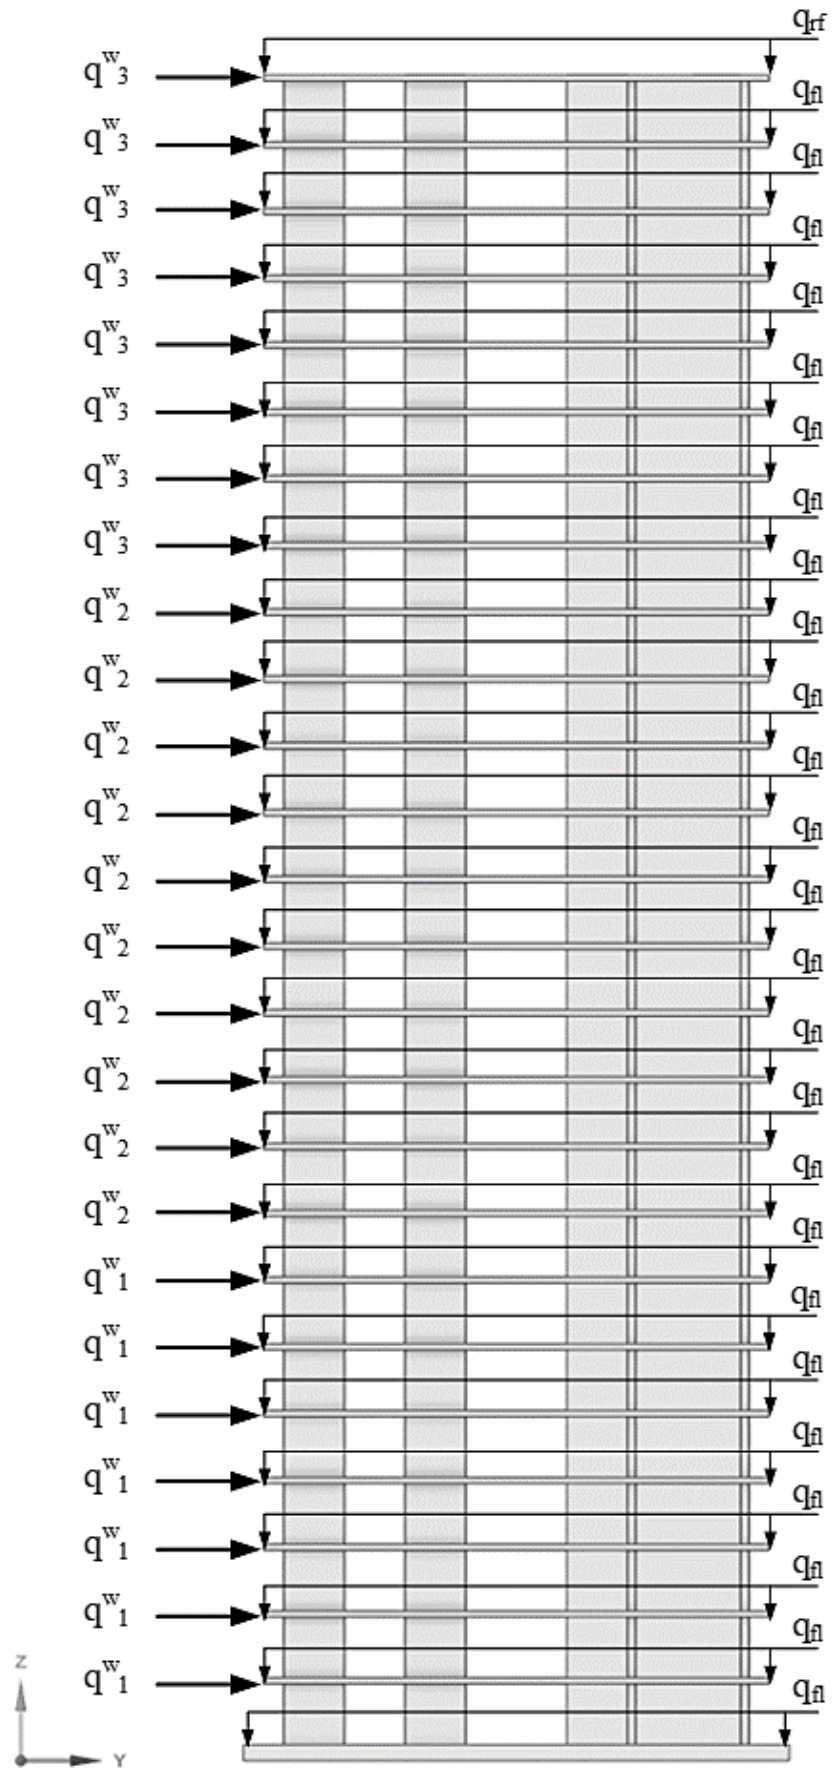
Западный фасад расчётной схемы (см. таблицу 4.6)
